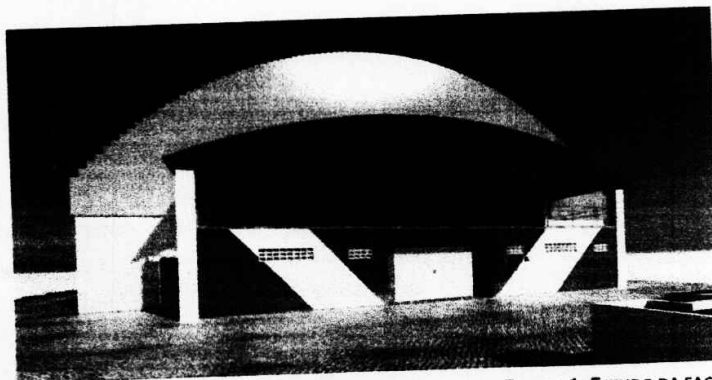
ESTUDO DA FACHADA (MAQUETE)
